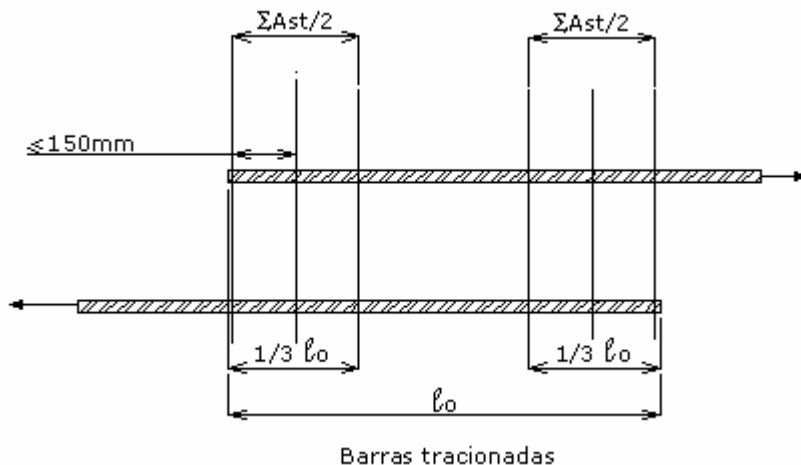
Armadura transversal nas emendas – barras tracionadas
